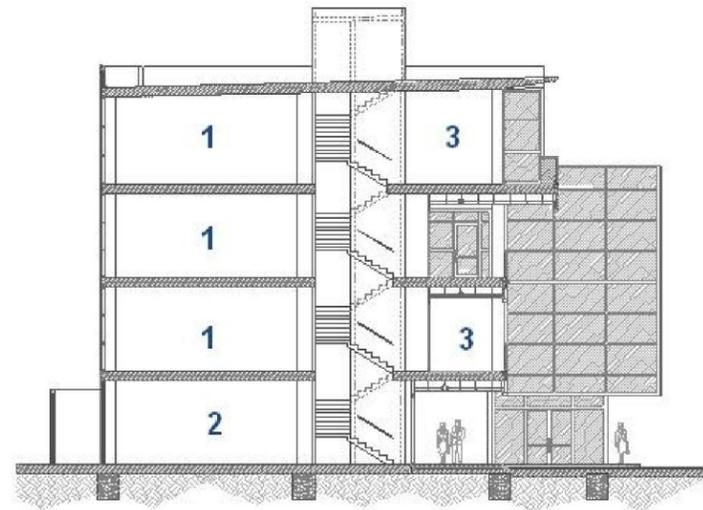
Corte transversal 109°28' Work Spaces Río
